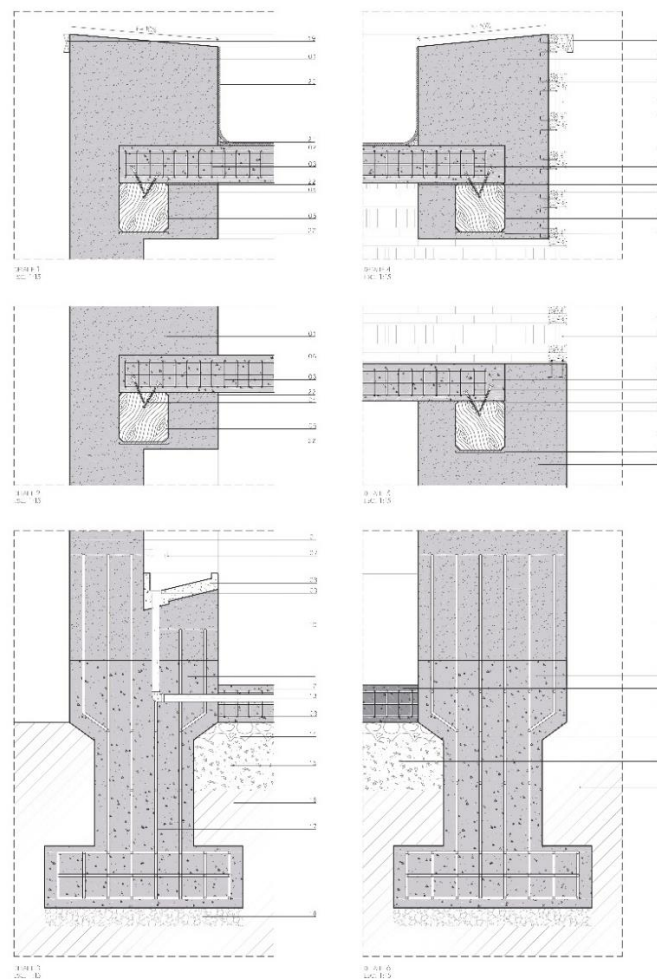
Detalle de corte por muro autoportante de suelo-cemento
